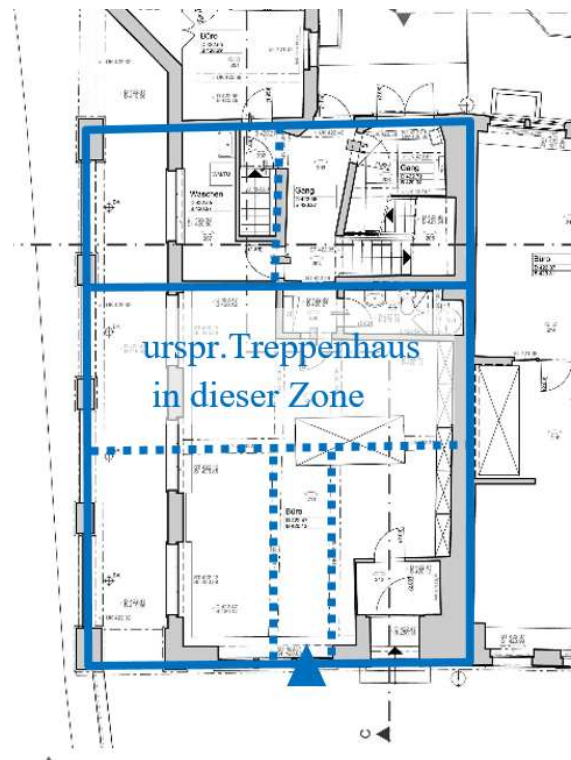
Grundriss Erdgeschoss. Hier sind wegen der starken baulichen Eingriffe in den 1980er Jahren aktuell kaum verlässliche Aussagen zum einstigen Grundriss möglich.
